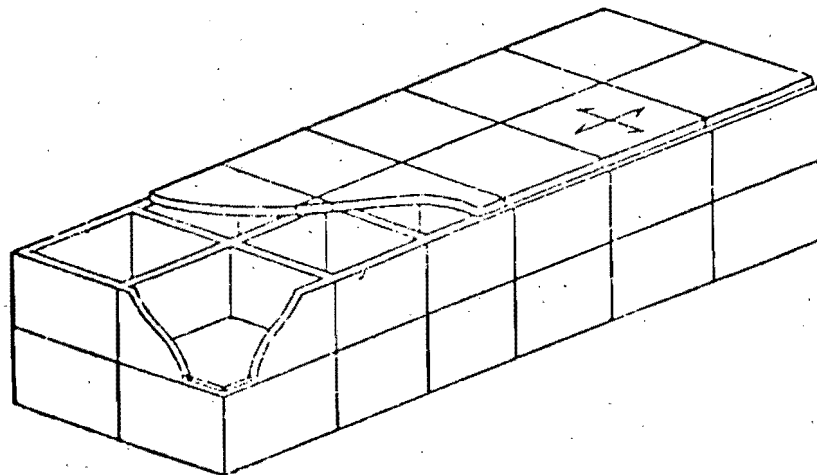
Sistema con muros de carga transversales y longitudinales (ref 3)
